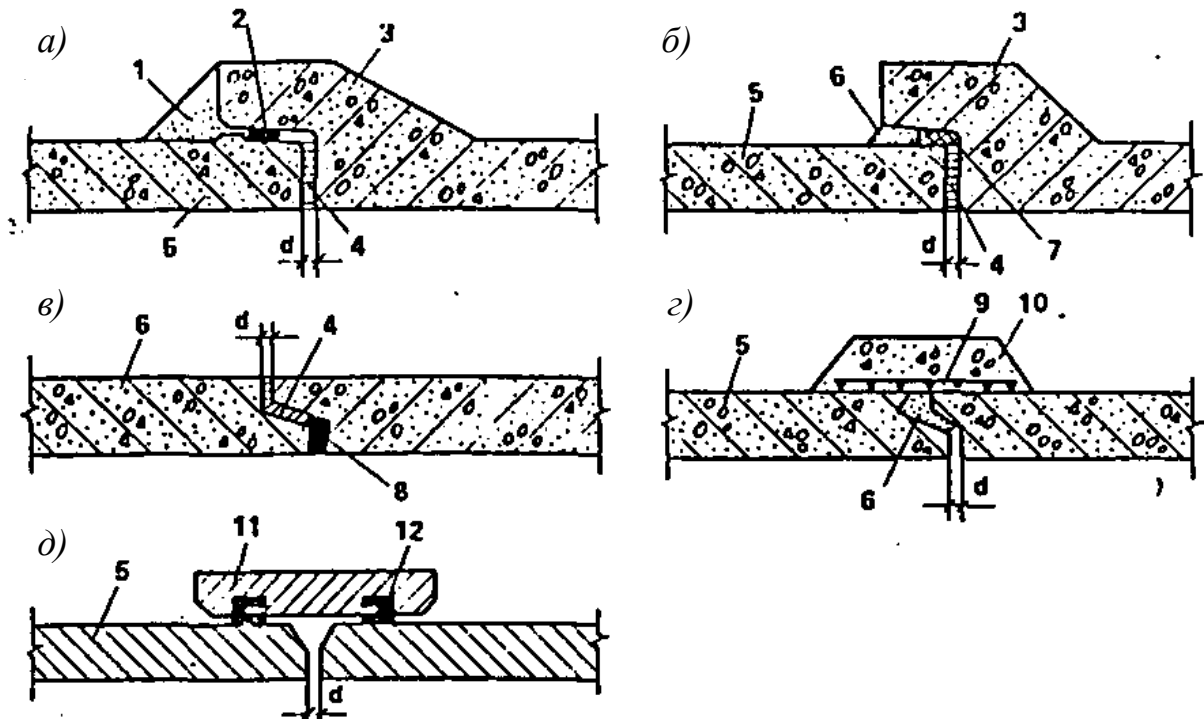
Стыковые соединения труб водостоков: а, б – соединения раструбных железобетонных труб; в, г – то же фальцевых; д – соединения асбоцементных труб на муфтах; 1 – замок из цементного раствора; 2 – резиновое кольцо; 3 – раструб; 4 – раствор на напрягающем цементе; 5 – труба; 6 – асбоцементный замок; 7 – смоляная прясть; 8 – герметик; 9 – арматурная сетка; 10 – бетонный пояс; 11 – асбоцементная муфта; 12 – резиновая манжета $d = 10 \dots 20$ мм
